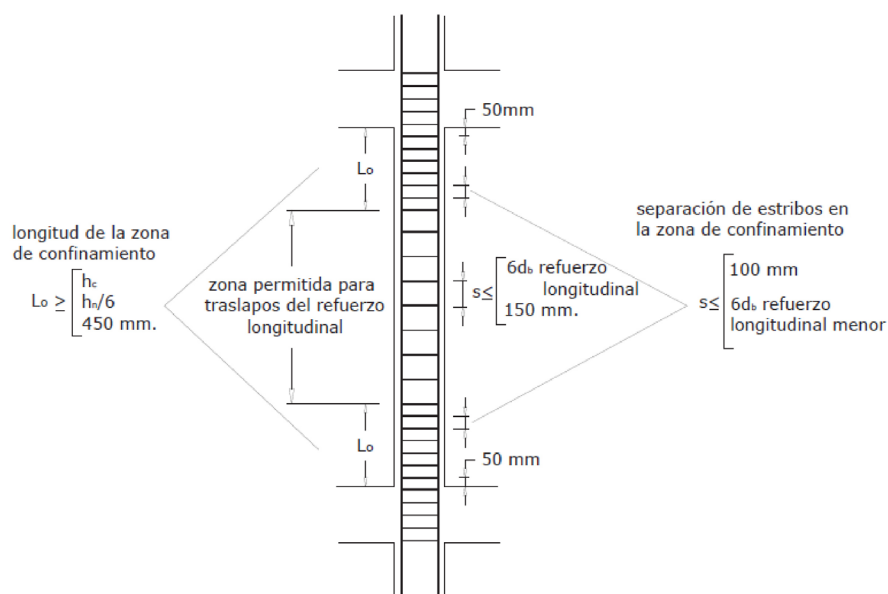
Separación de estribos en viviendas de más de 2 pisos o con luces mayores a 5m
